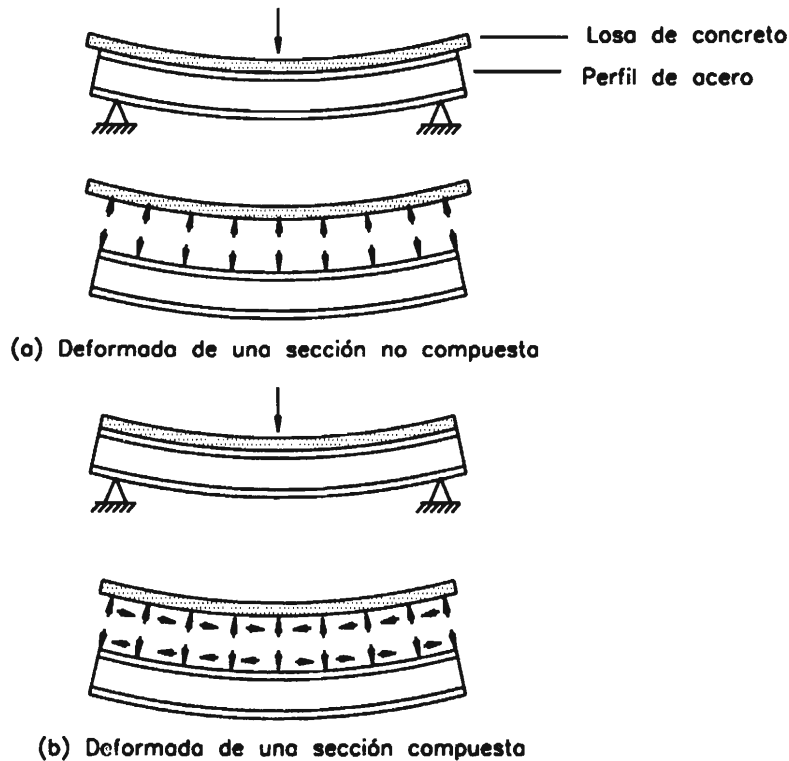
Efecto de la presencia de conectores de corte en vigas compuestas
